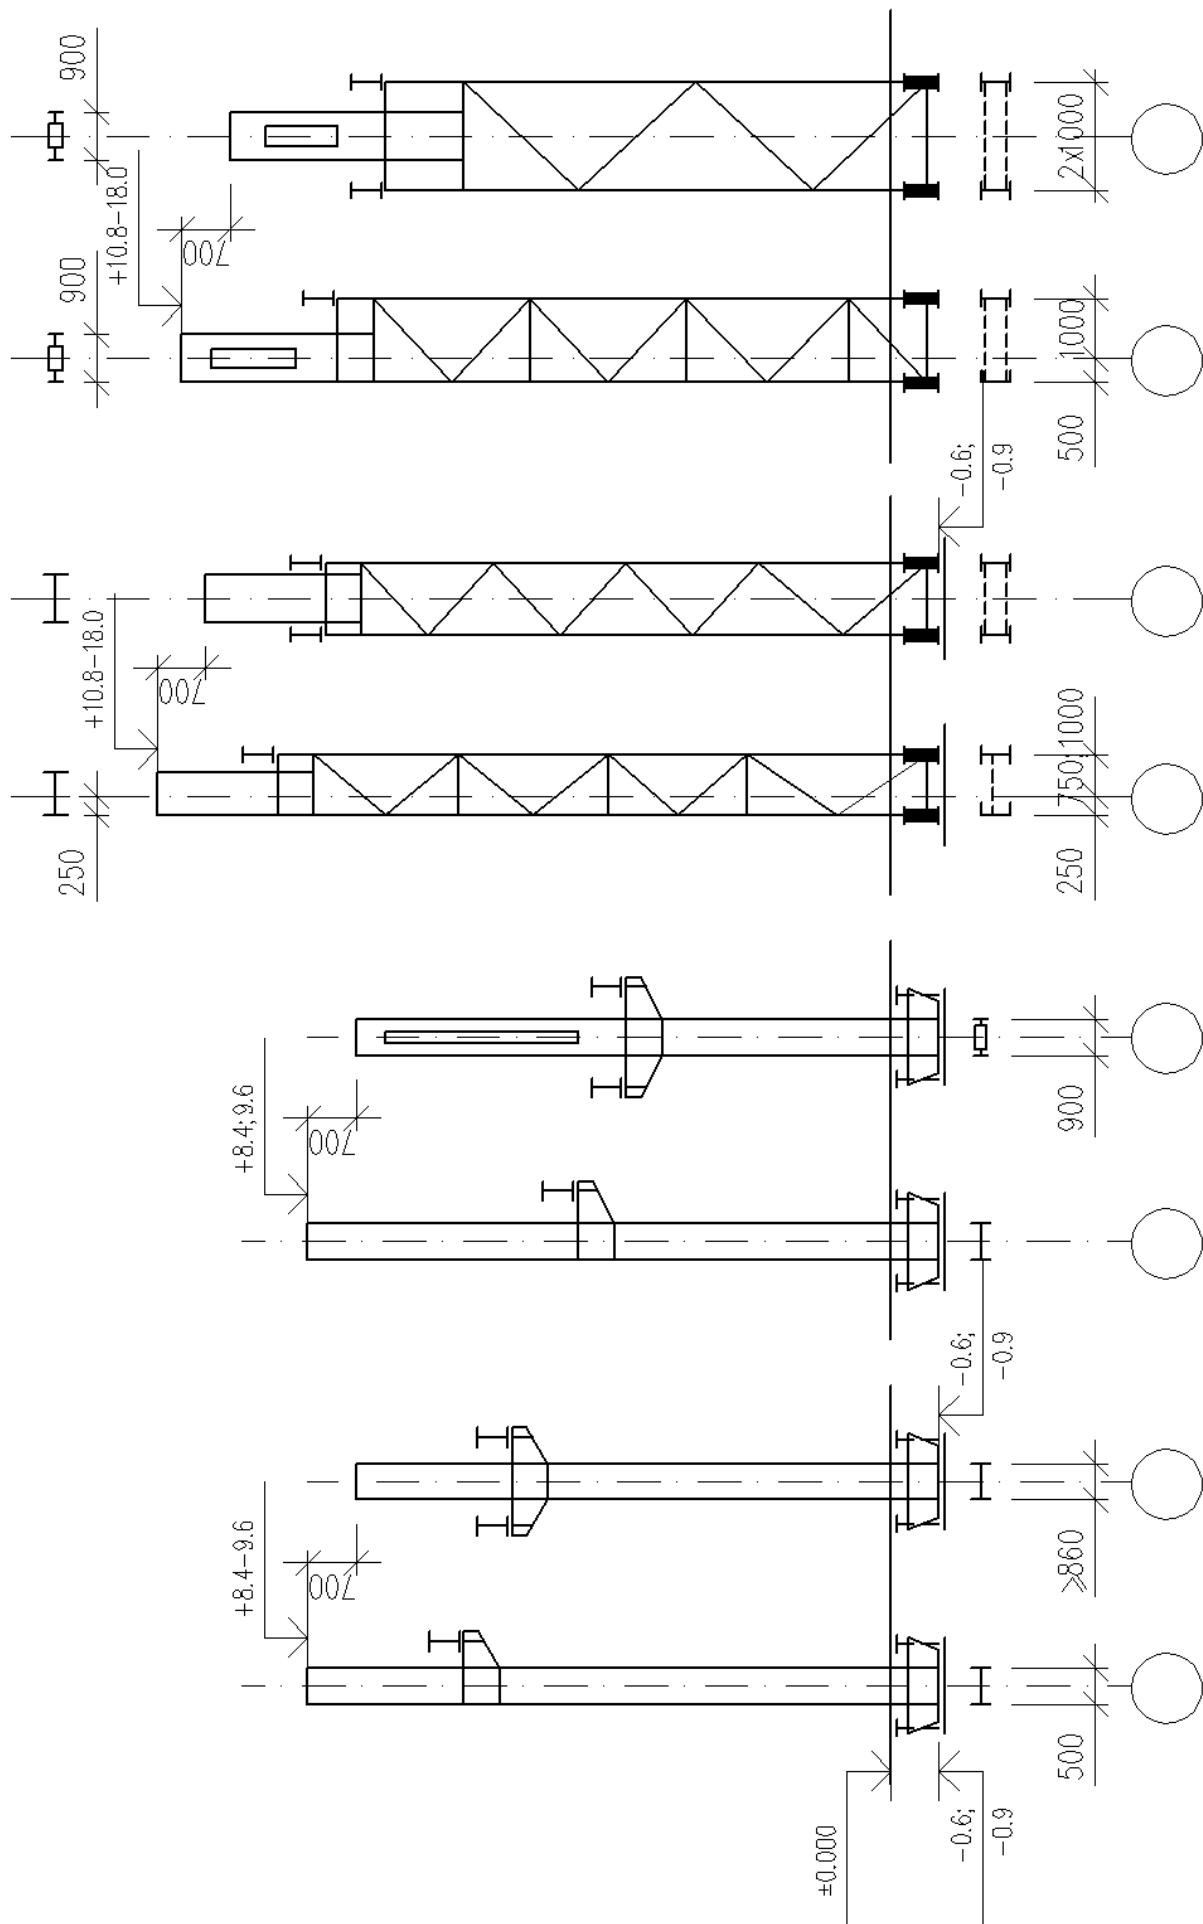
Стальные колонны для зданий с опорными кранами грузоподъемностью 10 – 125 т (серия 1.424-2)
